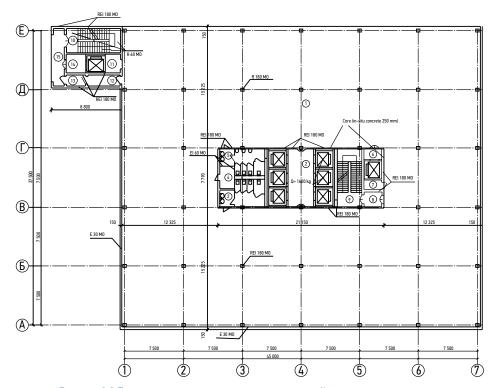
План типового этажа при короткопролетной схеме каркаса здания. Внутренние колонны по осям Б, В, Γ и Д отсутствуют на длиннопролетной схеме
